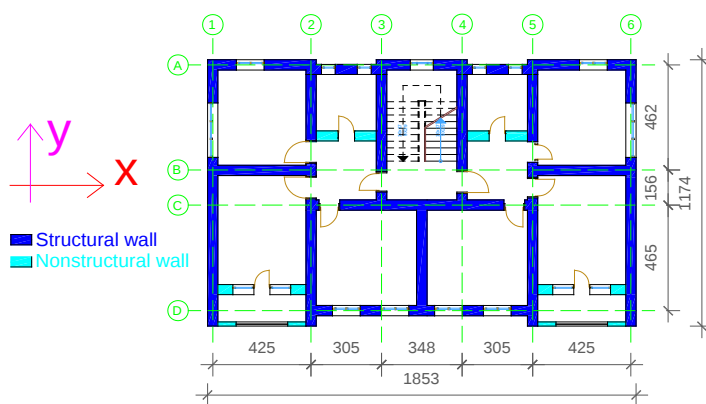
Planimetria e ndërtesës të analizuar sistem me mure masive mbajtëse
